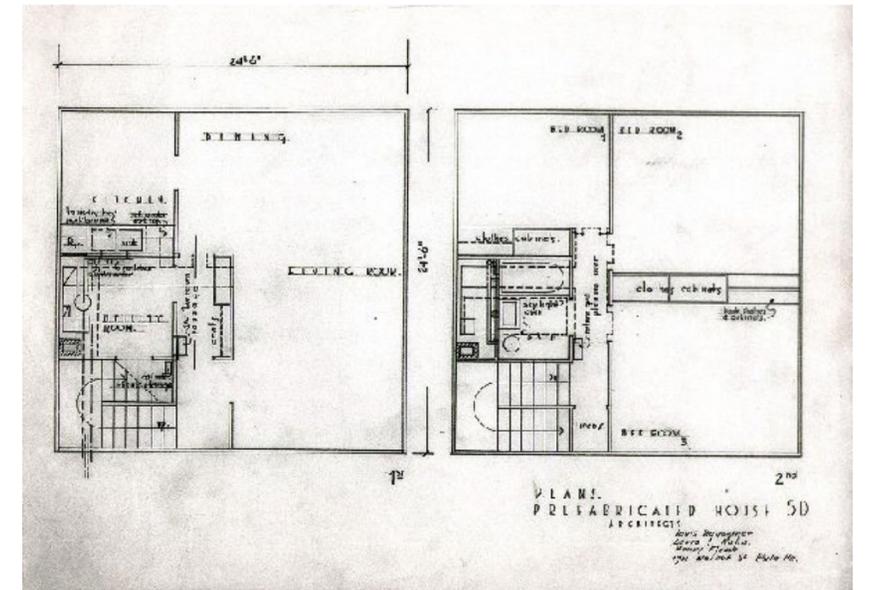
Kahn y Henry Klumb. Plantas de la casa prefabricada. 1937.
